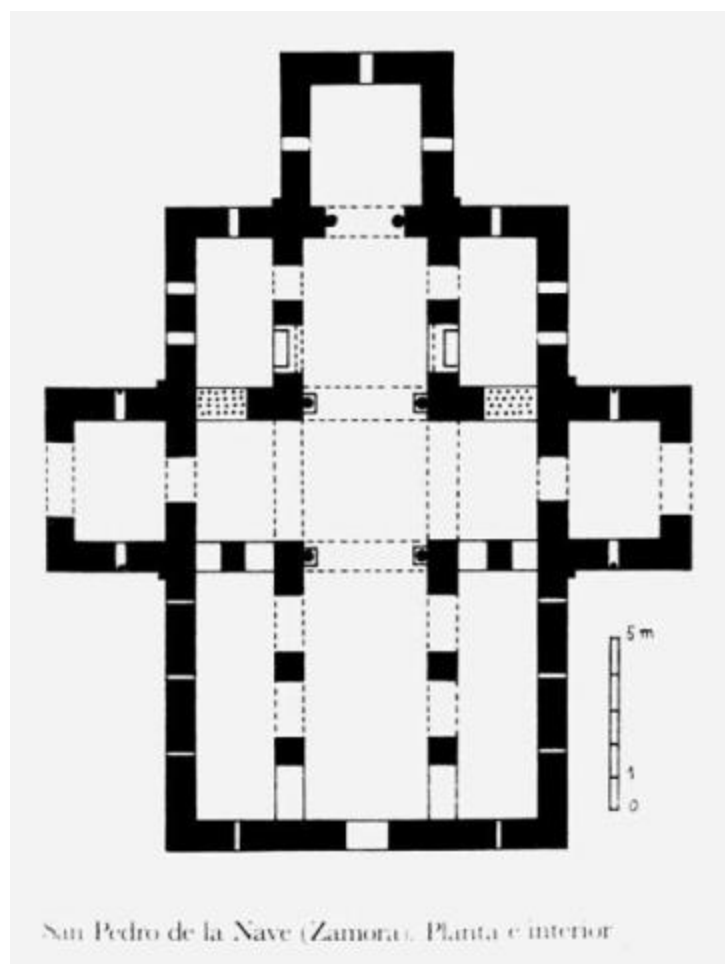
Planta de San Pedro de la Nave, Zamora, siglo VIII.
